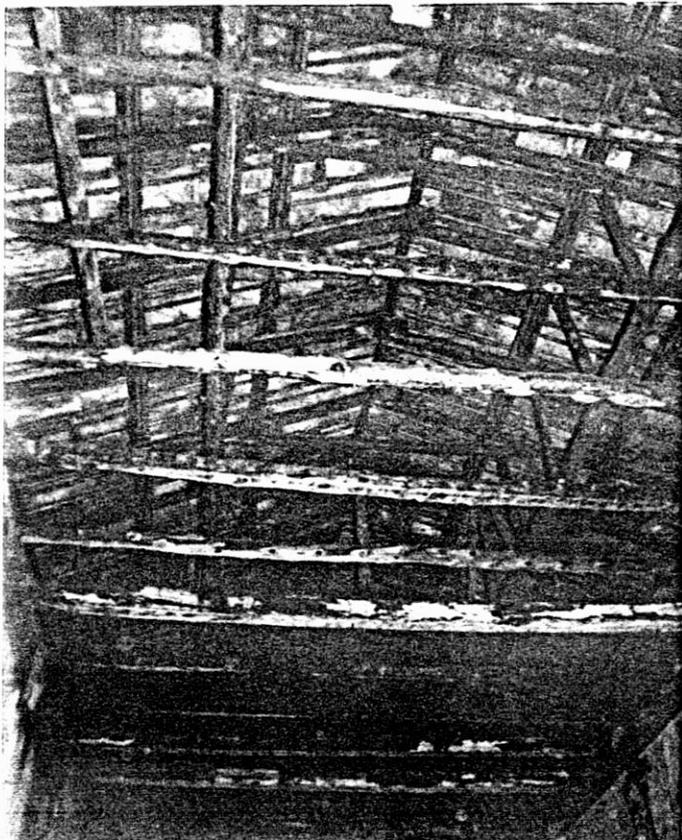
Detalle de techo reconstruido en vivienda colonial (Popayán)
